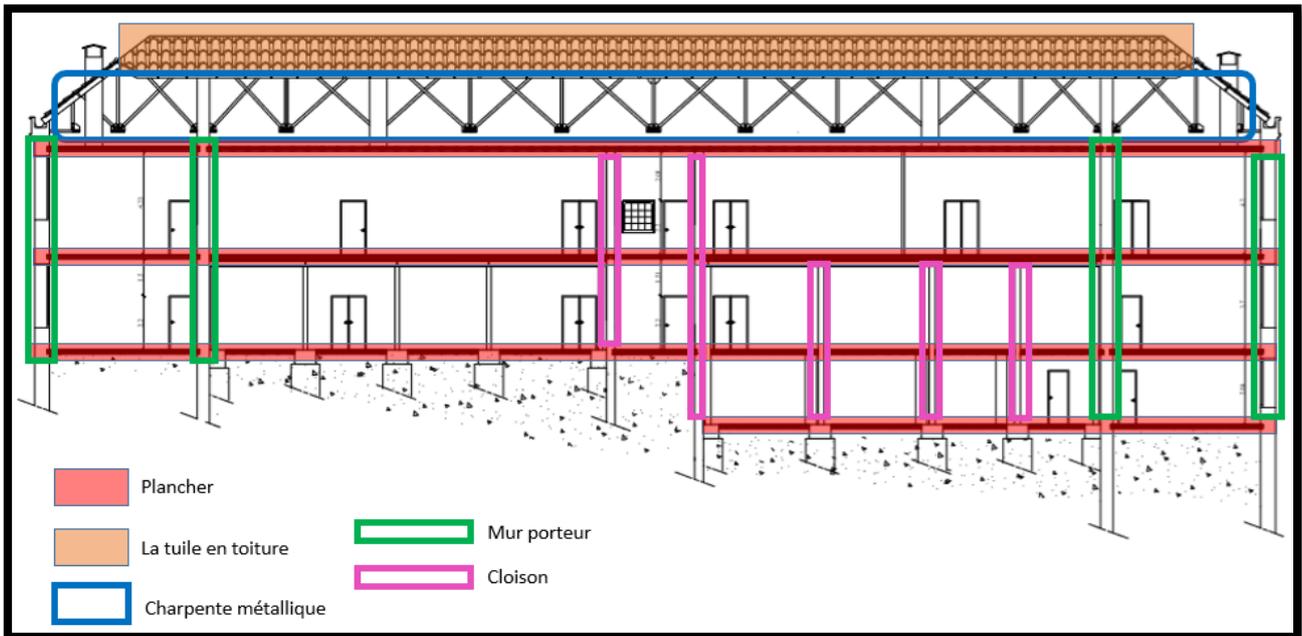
coupe sur le bâtiment montrant les différents éléments de construction
